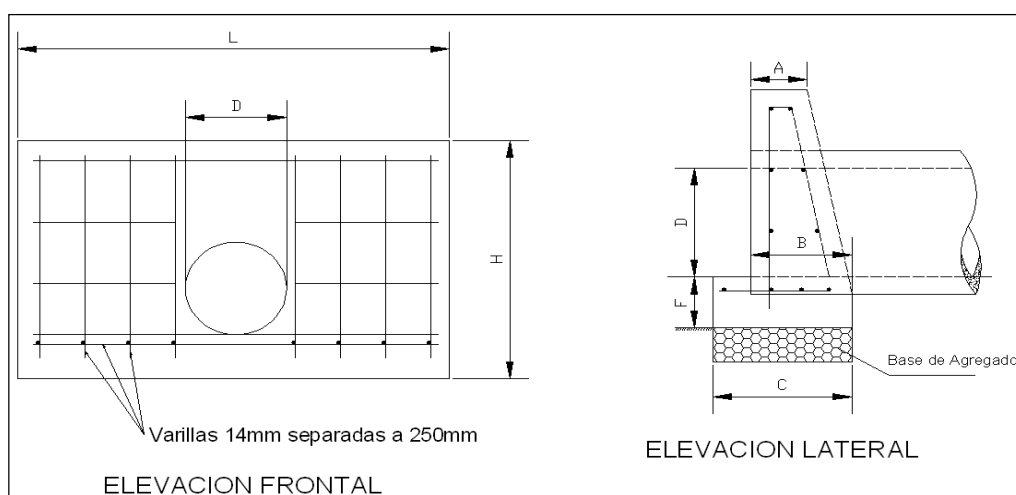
Esquema de tipos de entradas y salidas de alcantarillas
